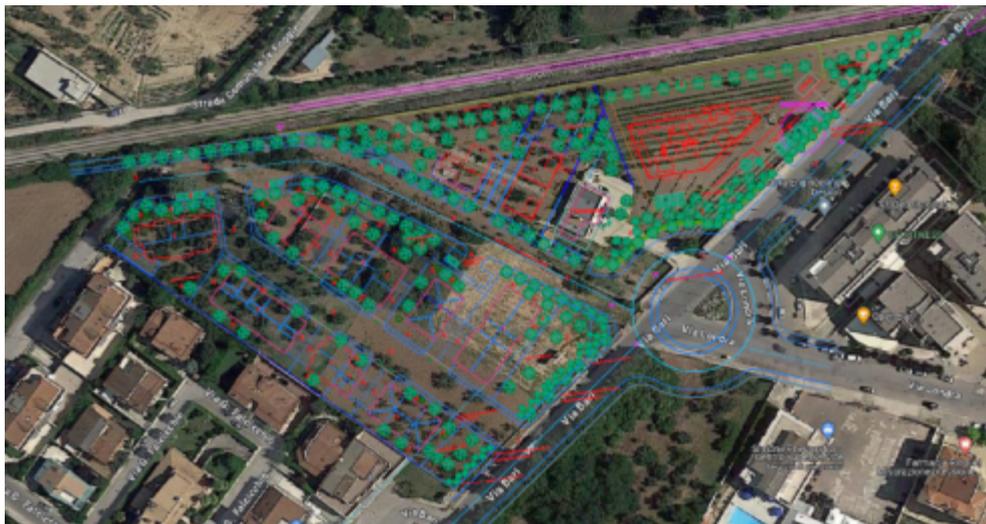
Planimetria su ortofoto (cfr. TAVOLA 1 PPTR.pdf.p7m)
